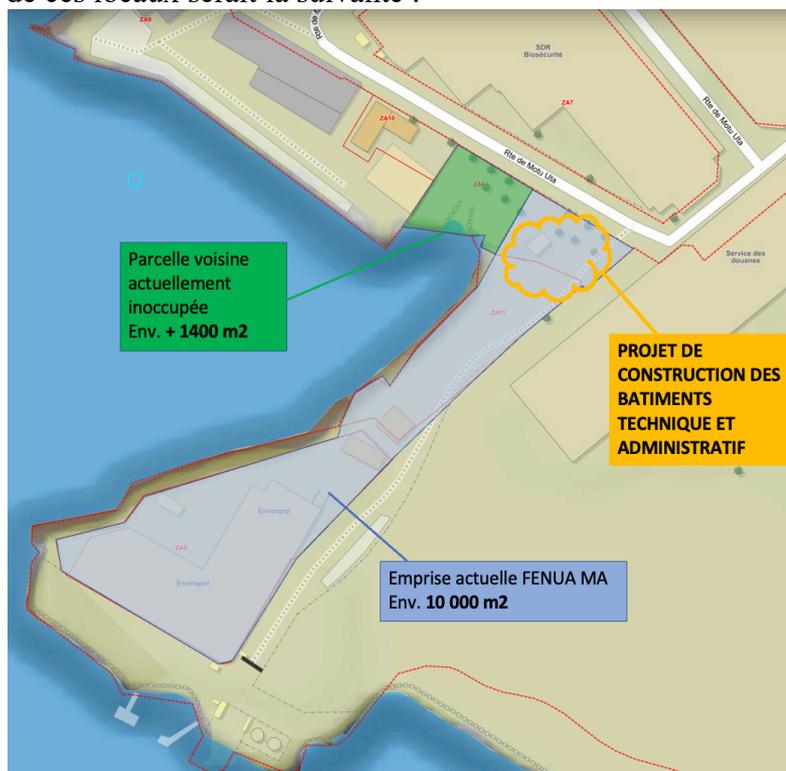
PLAN D'IMPLANTATION GENERAL DU PROJET
